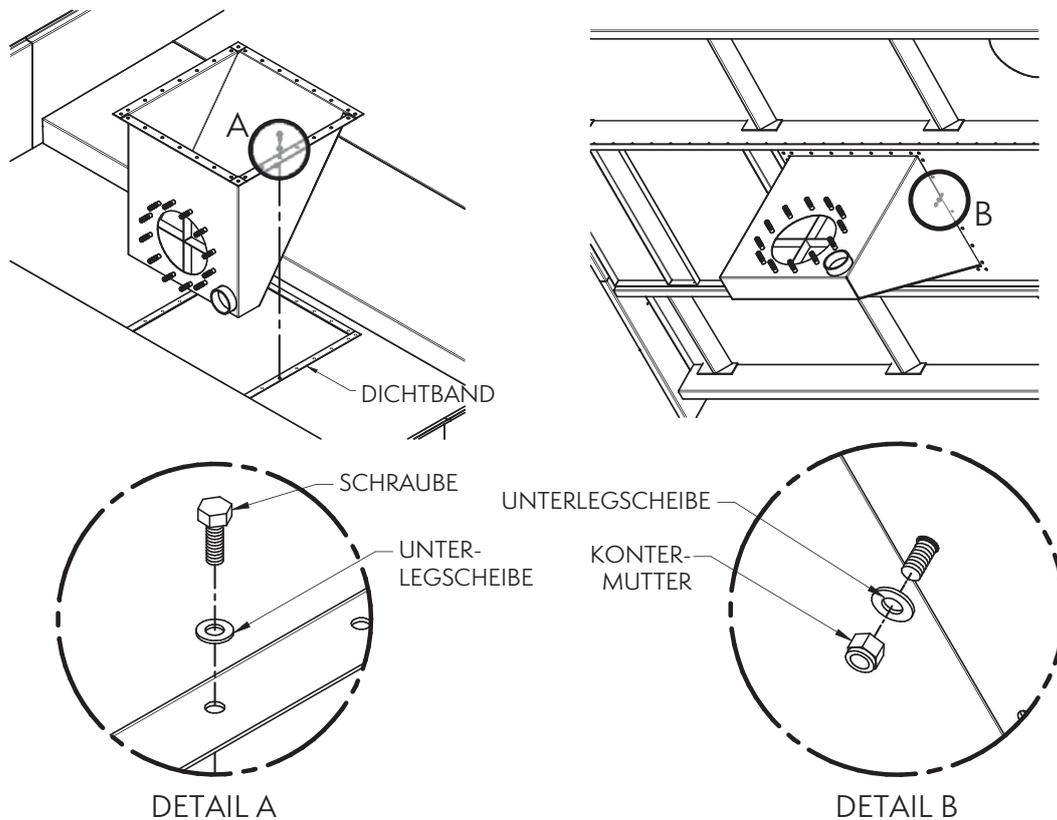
Installation eines Sinkkastens mit seitlichem Auslass
